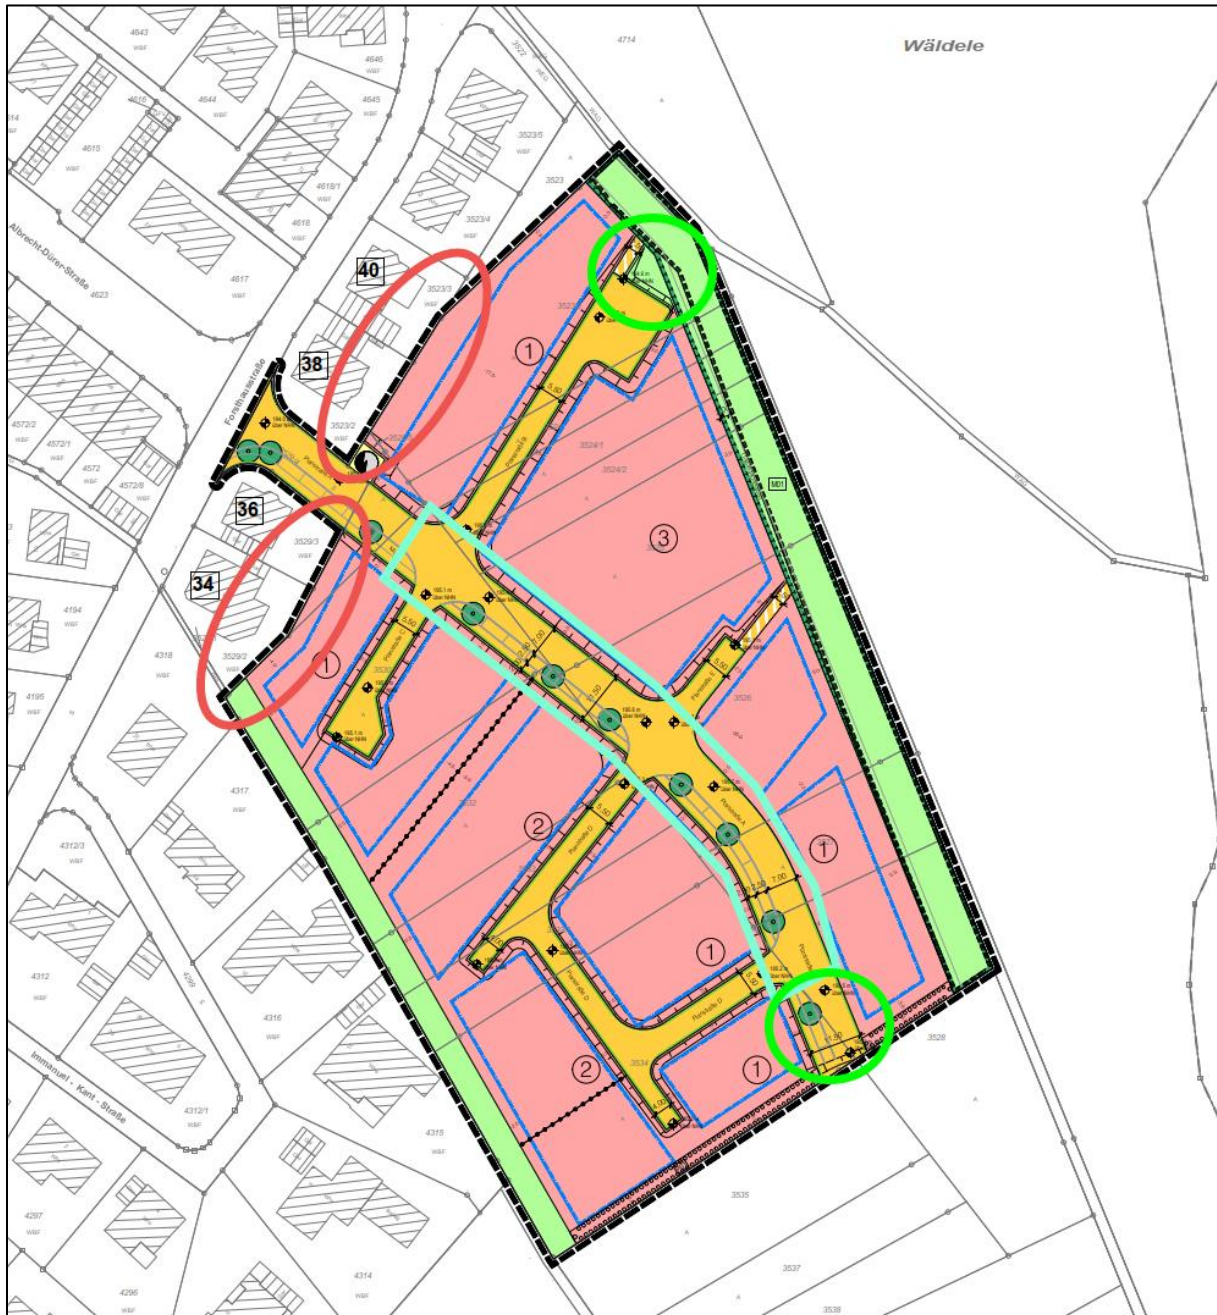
Bebauungsplan "Gereut", rechtskräftig seit dem 04.10.2023, mit Eintragung der Änderungsbereiche (rot = Stützmauern, grün = Versickerungsmulden, blau = Straßenoberflächen); Quelle: Gemeinde Teningen, eigene Darstellung
